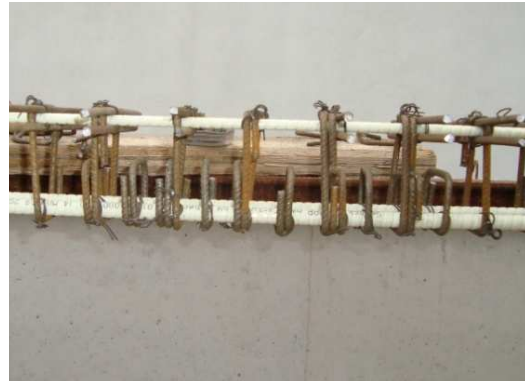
Construção/pormenorização do confinamento do betão no apoio central da viga G3-b
